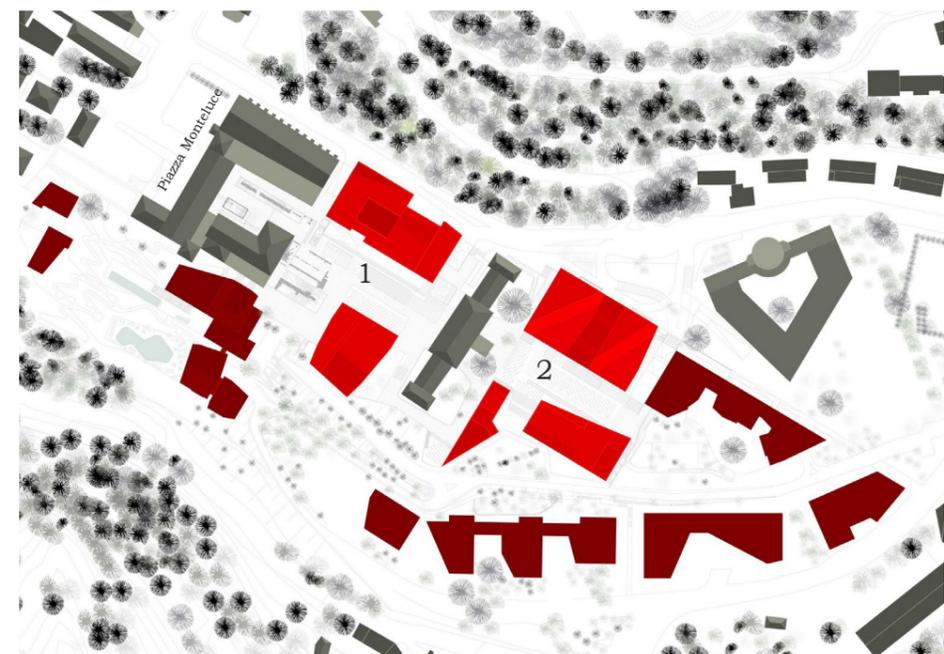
Masterplan di progetto con indicazione delle piazze
